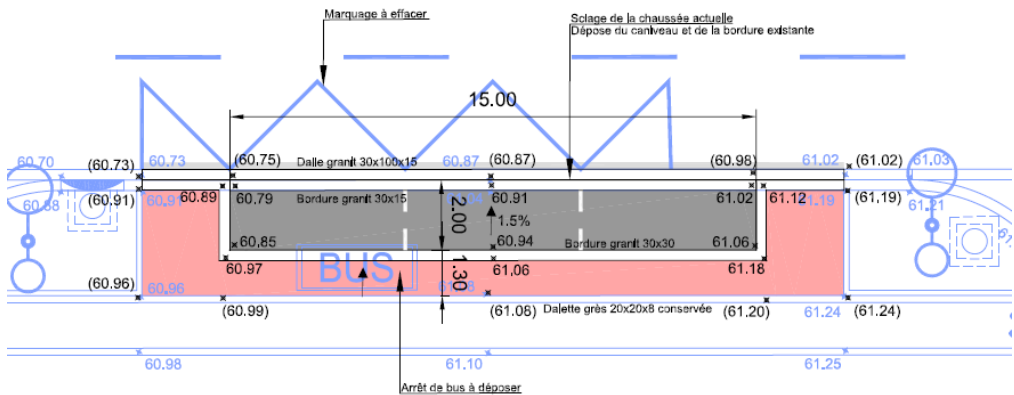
Extrait du plan d'aménagement des places de stationnement
